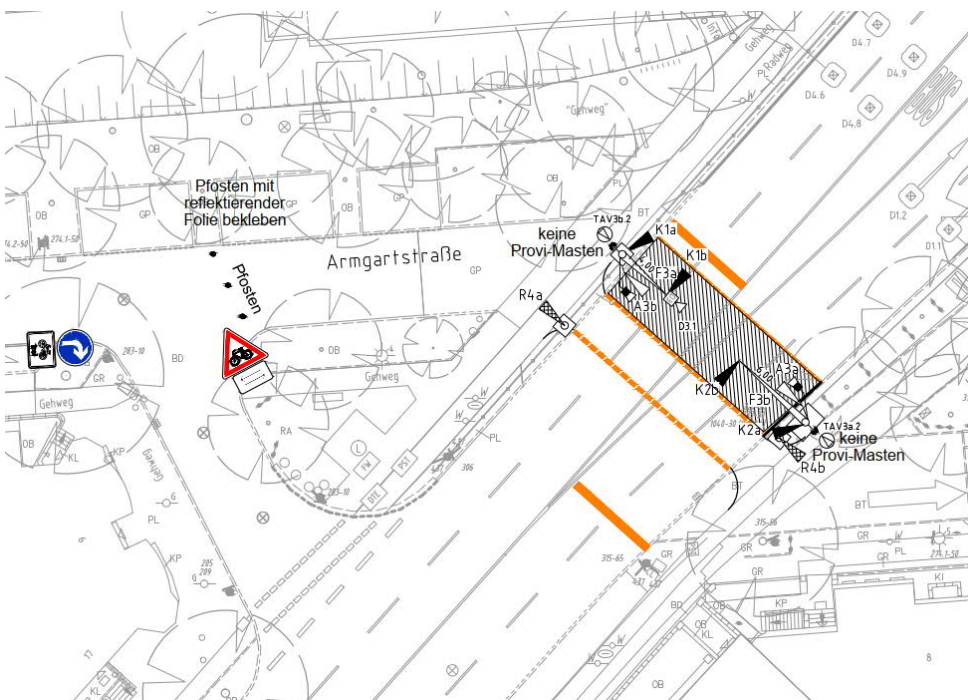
Lageplan-Ausschnitt mit Knotenpunkt Mundsburger Damm / Armgartstraße (Bauzustand; Quelle: BKP)
